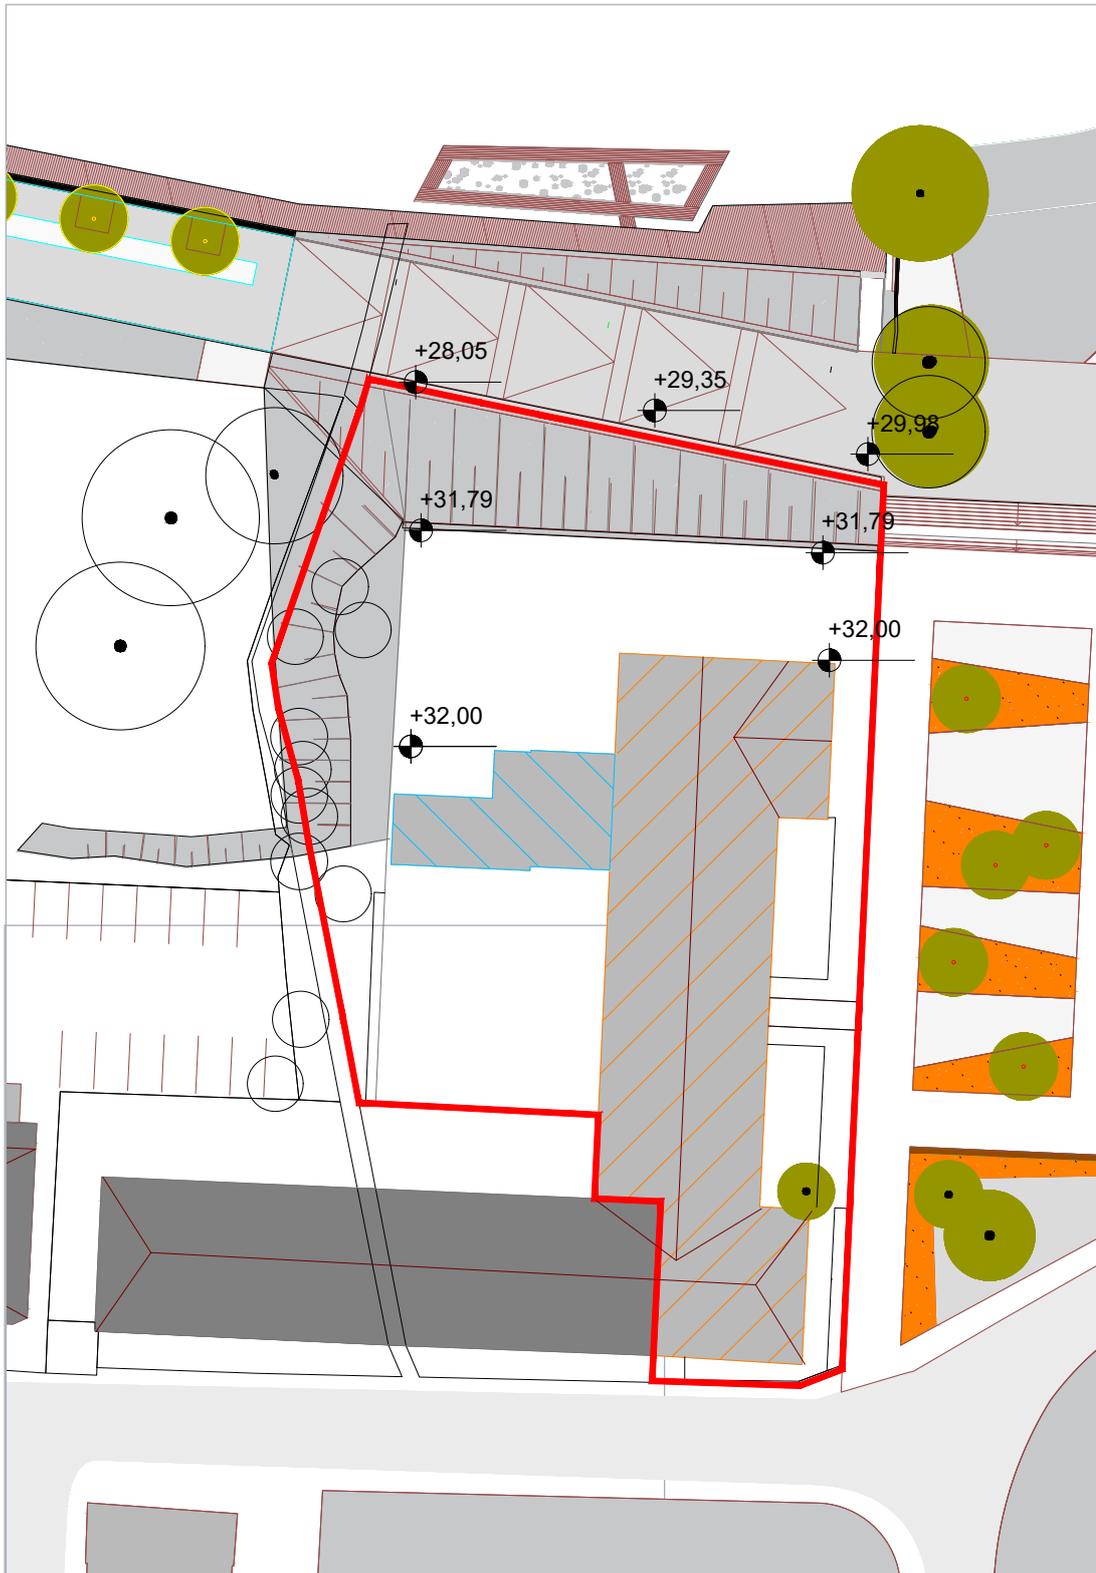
| Lageplan mit Markierung des Wettbewerbsgebiets
